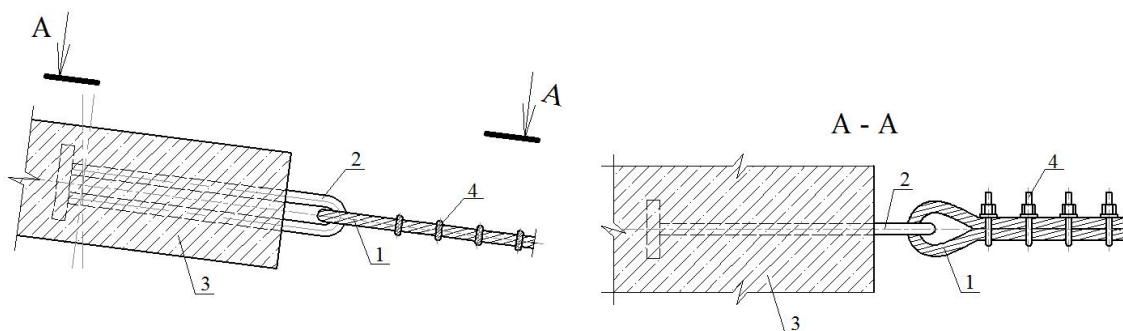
Крепление вант к наружному опорному контуру вантового покрытия с помощью закладной детали «петля»: 1 – вант (стальной трос); 2 – закладная деталь (ЗД) в виде петли; 3 – наружный железобетонный опорный контур; 4 – хомут
